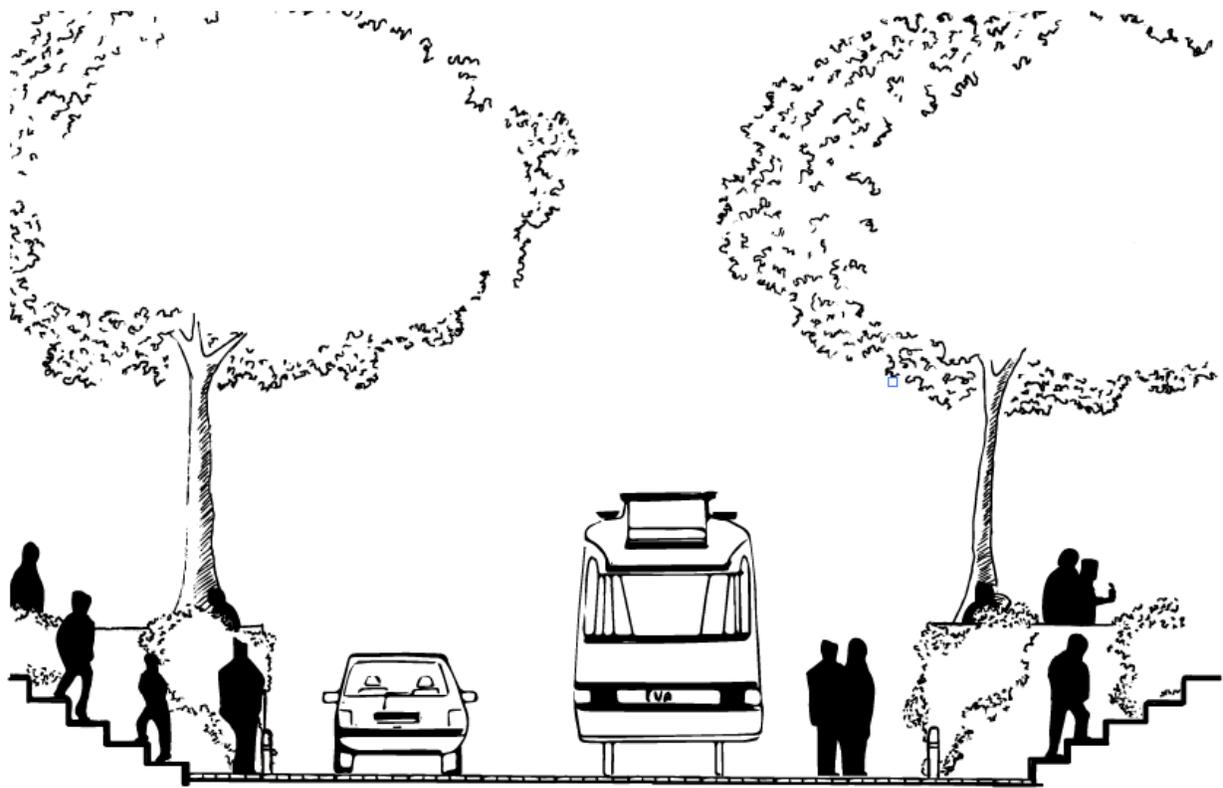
Croquis esquemático de la sección vial con tranvía.
